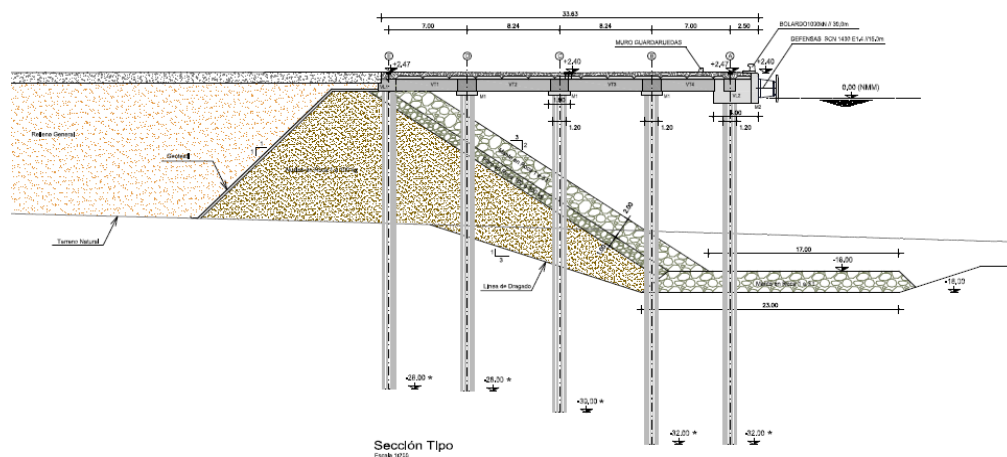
Perfil transversal tipo da construção do aterro do Porto de La Guaira (imagem cedida por Teixeira Duarte Engenharia e Construções, S.A.)
